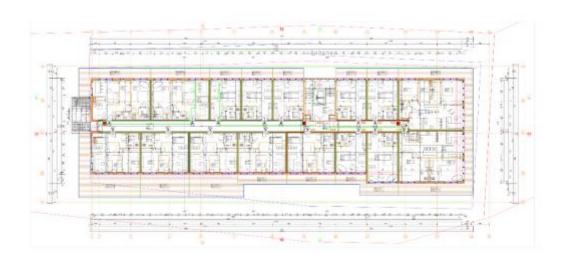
Grundriss 2. Obergeschoss (nicht maßstäblich)
